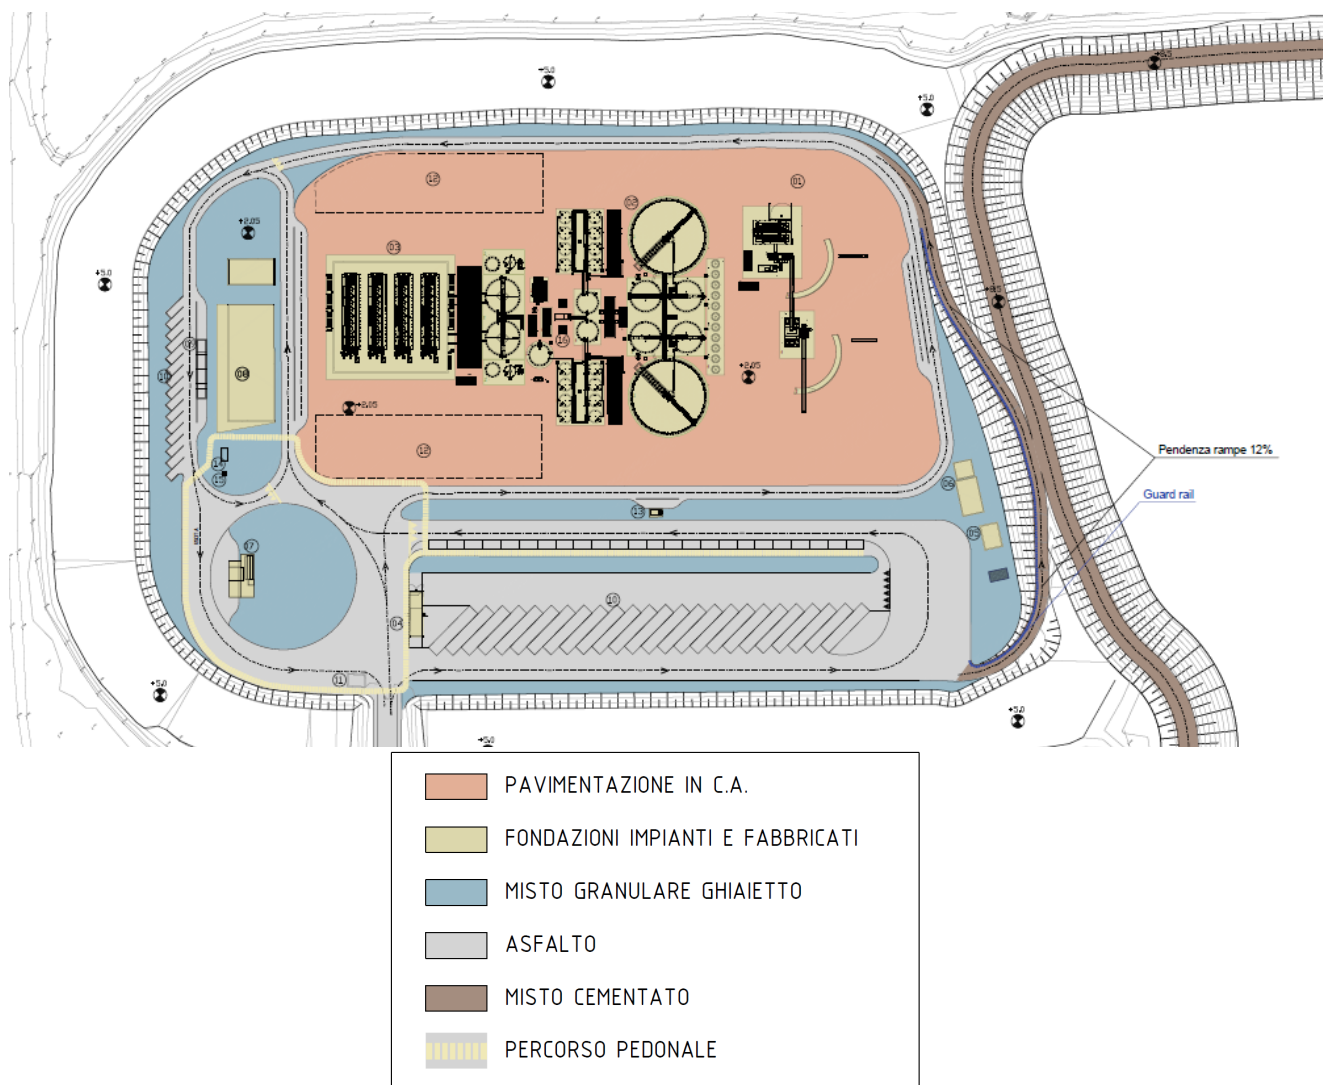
Stralcio elaborato relativo alle pavimentazioni
